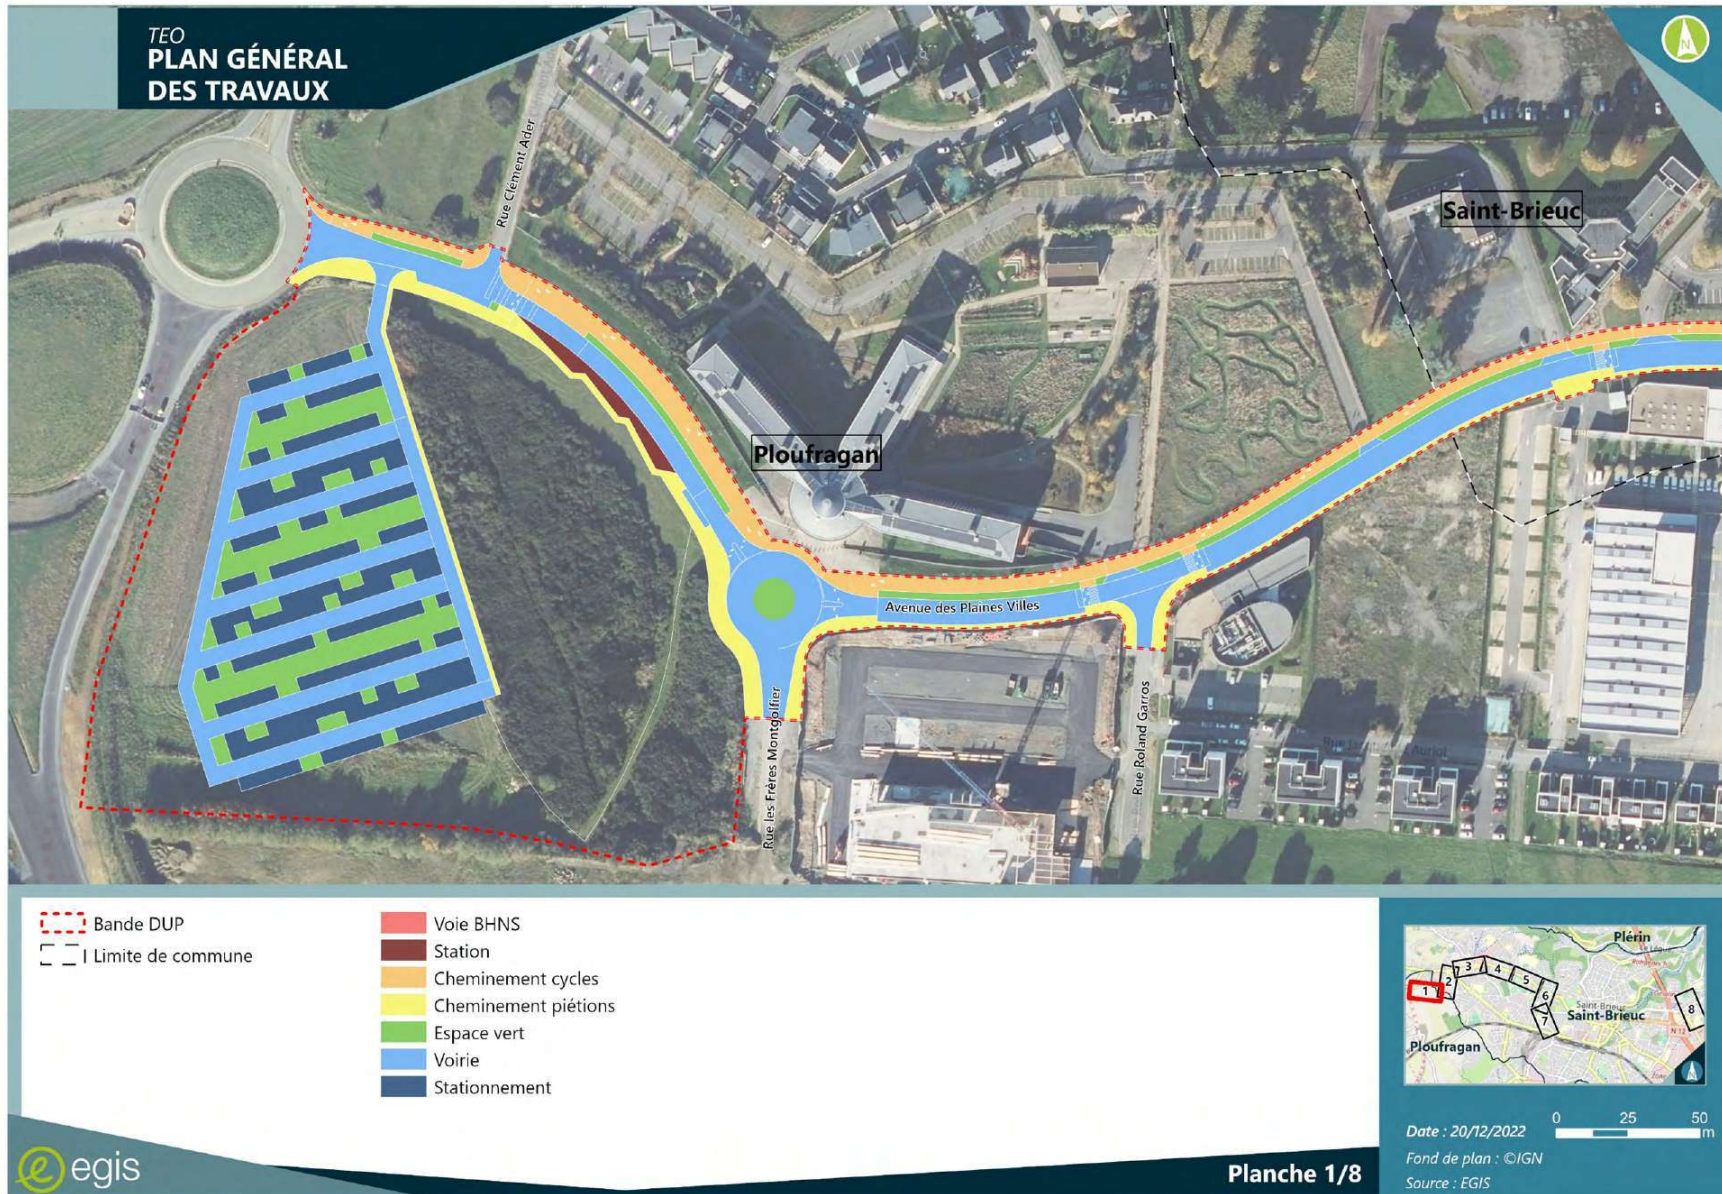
Plan général des travaux 1/8 (Source : EGIS)
